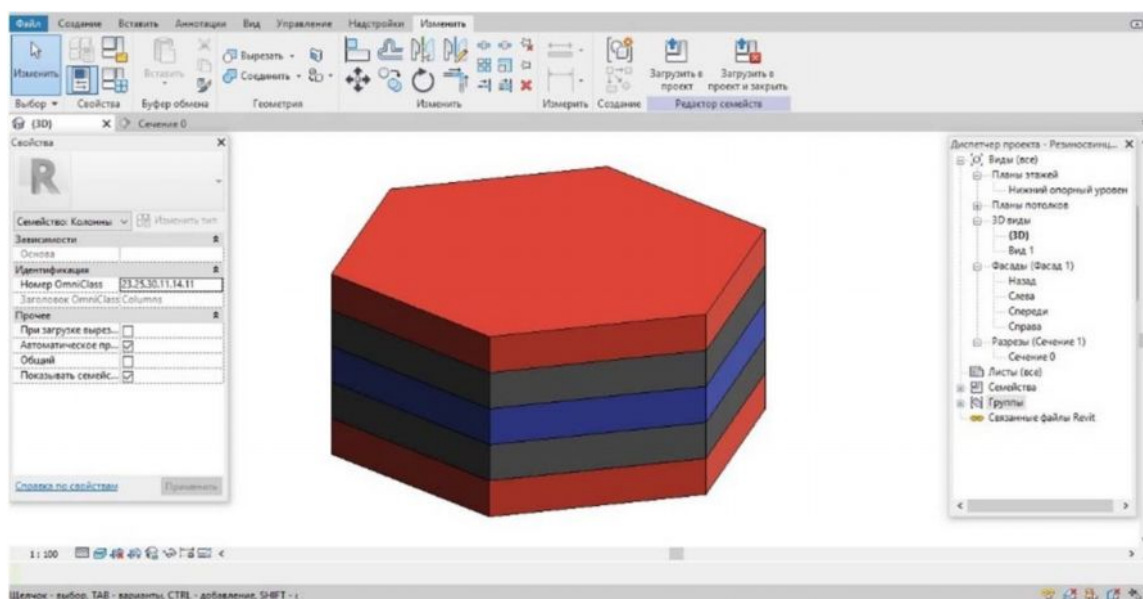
Конструкция резинометаллического изолятора со свинцовой пластиной, 3D вид
